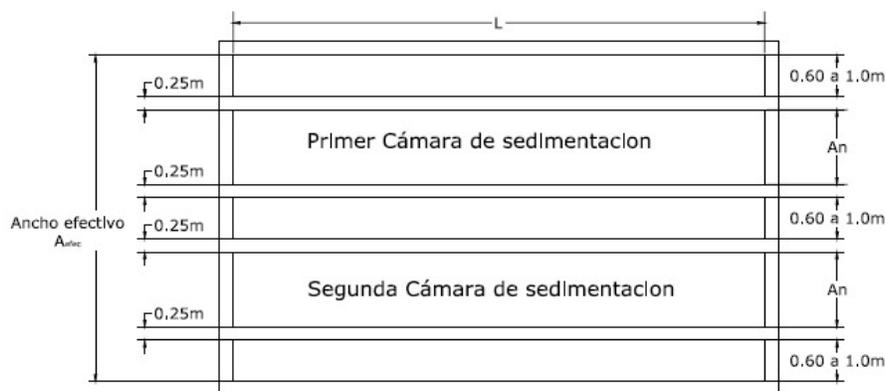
12 esquema de dimensionamiento de las cámaras sedimentadoras
